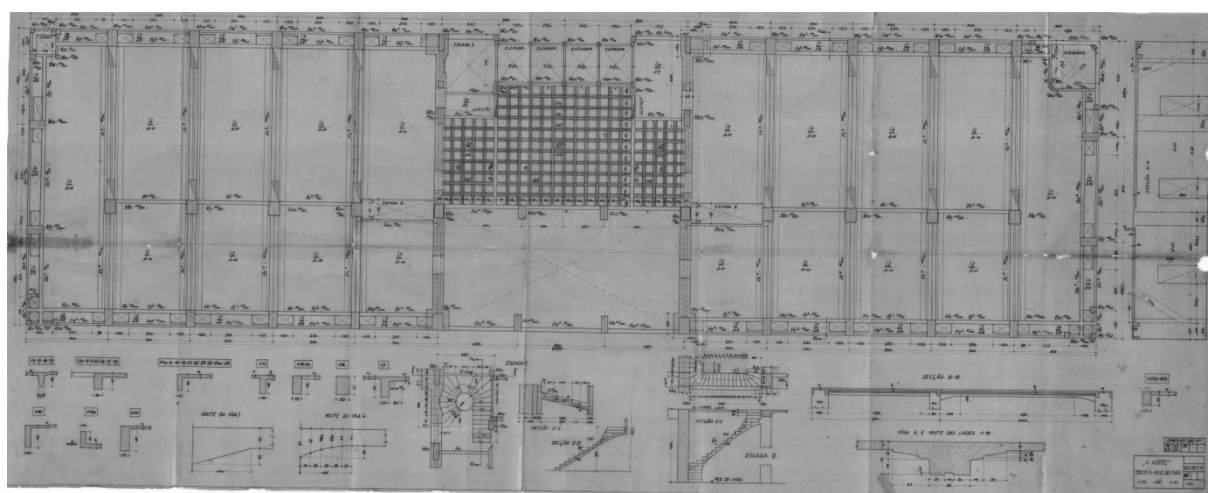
Planta estrutural do Teto do Réz do Chão. FONTE: SEEBLA, 2014.
